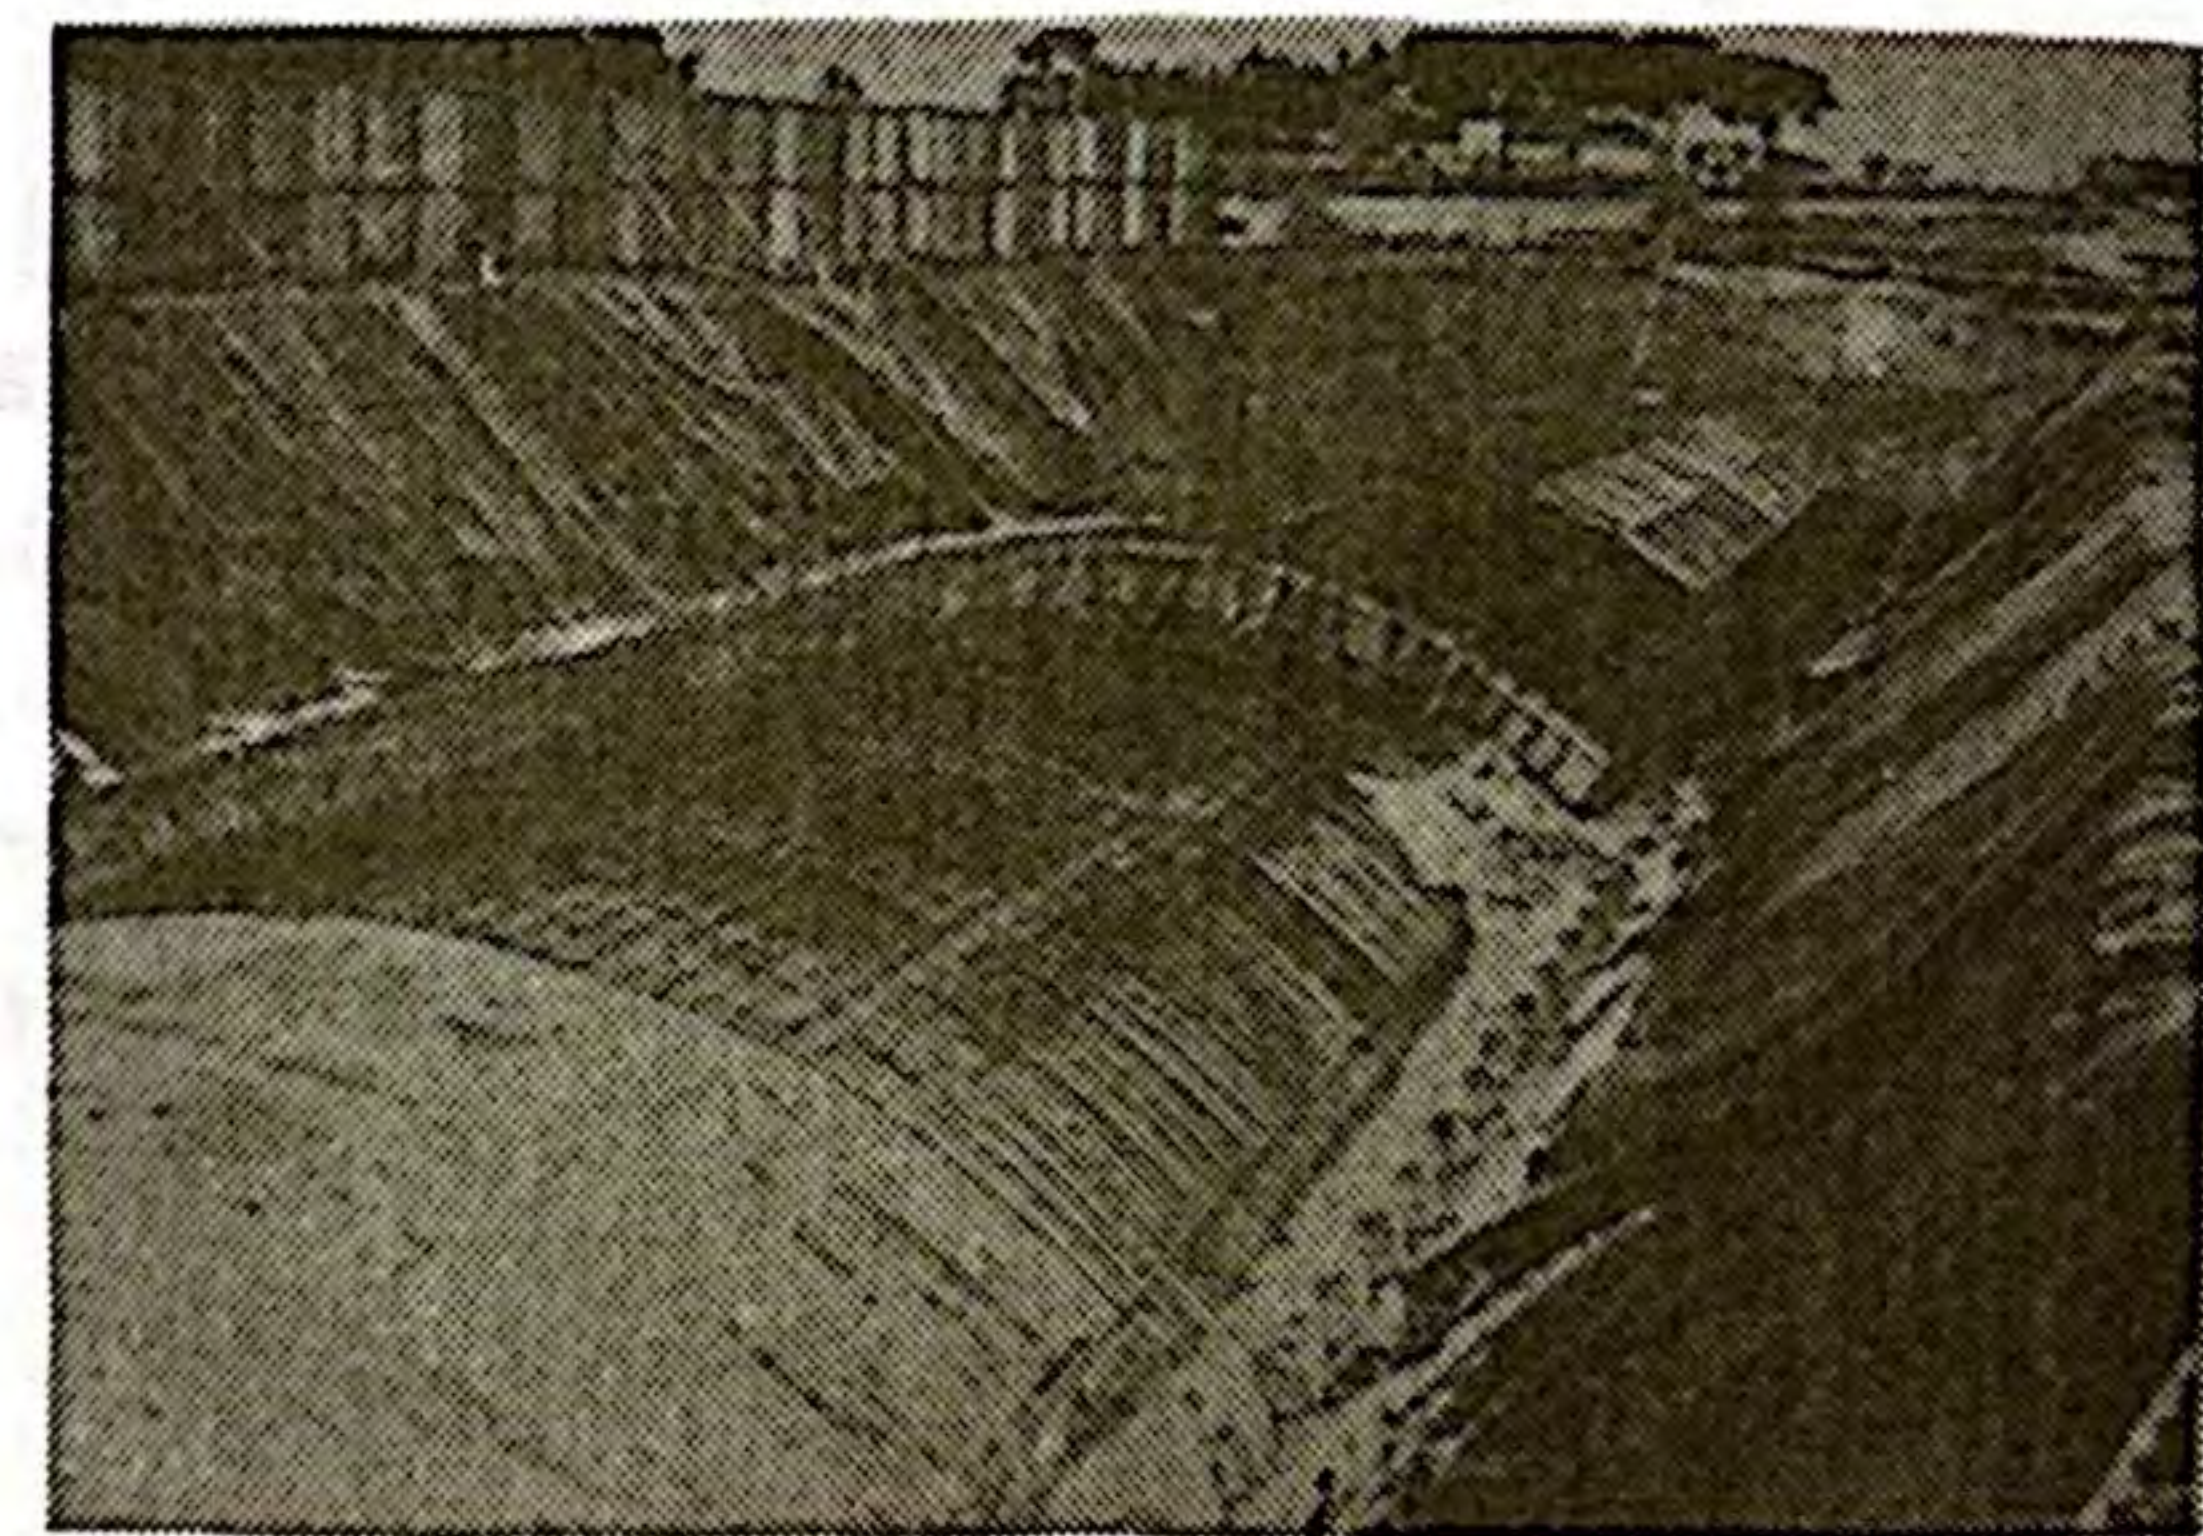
Vista da Trincheira Escavada, Forma e Armação da Laje de Teto.
